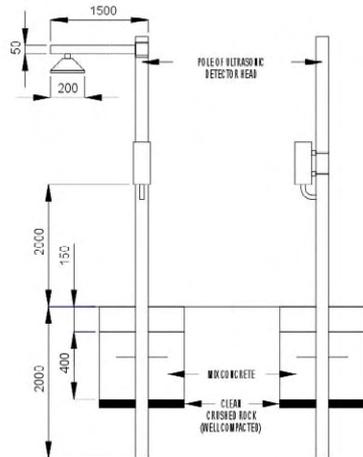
Plan de Instalación Estándar para el Sensor y Cabina
